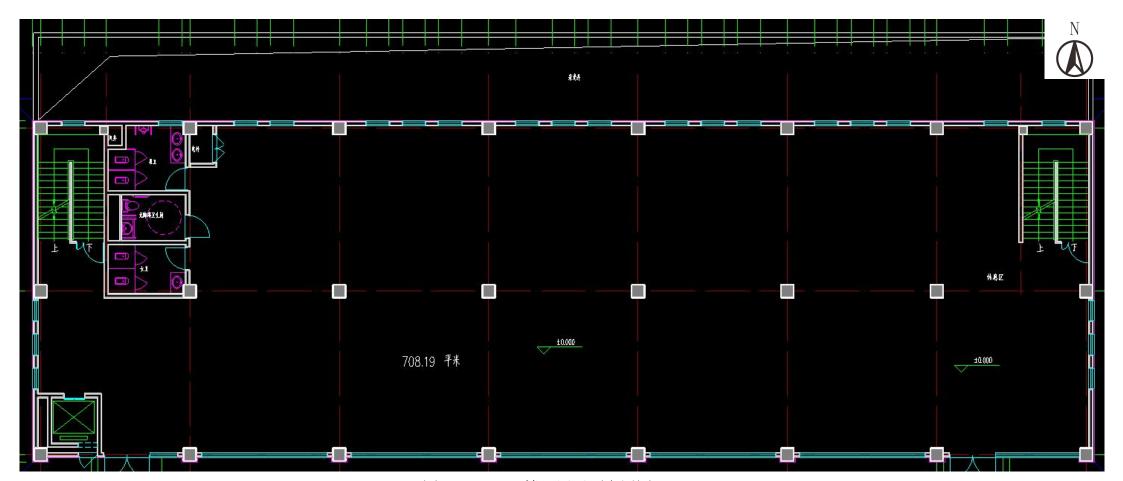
3#楼 1 层平面布置图(1: 100)
